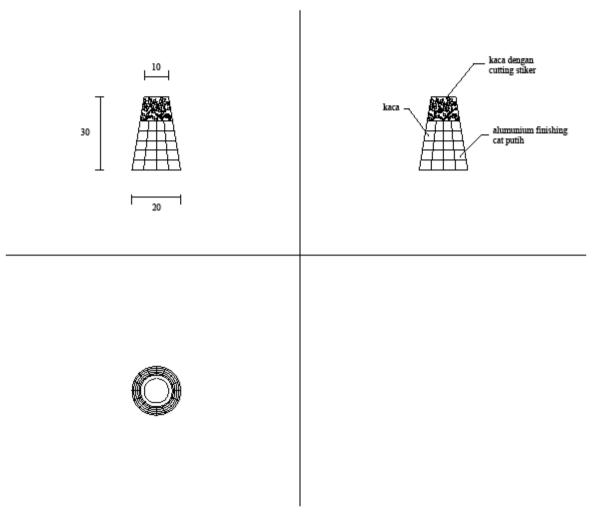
Detail Furnitur 6 (Sundeck 2)
